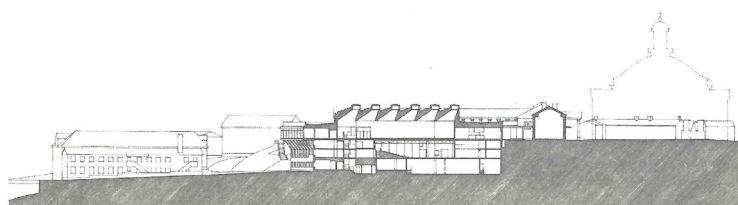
Fundação Pilar y Joan Miró, Palma de Maiorca, Rafael Moneo
